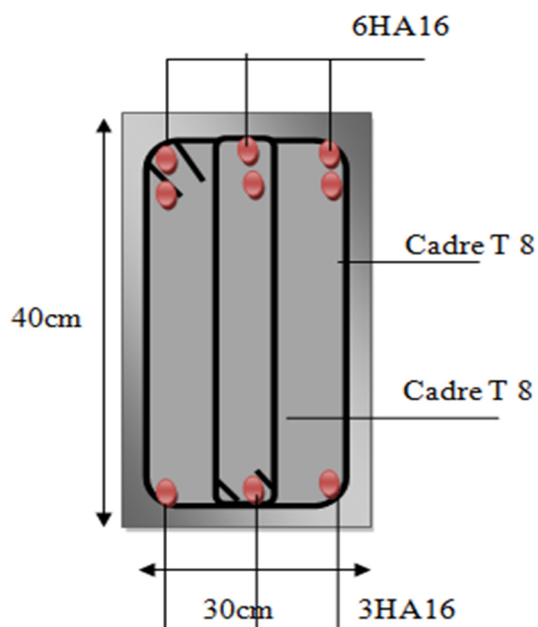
Schéma de ferrailage des Poutres secondaires.
